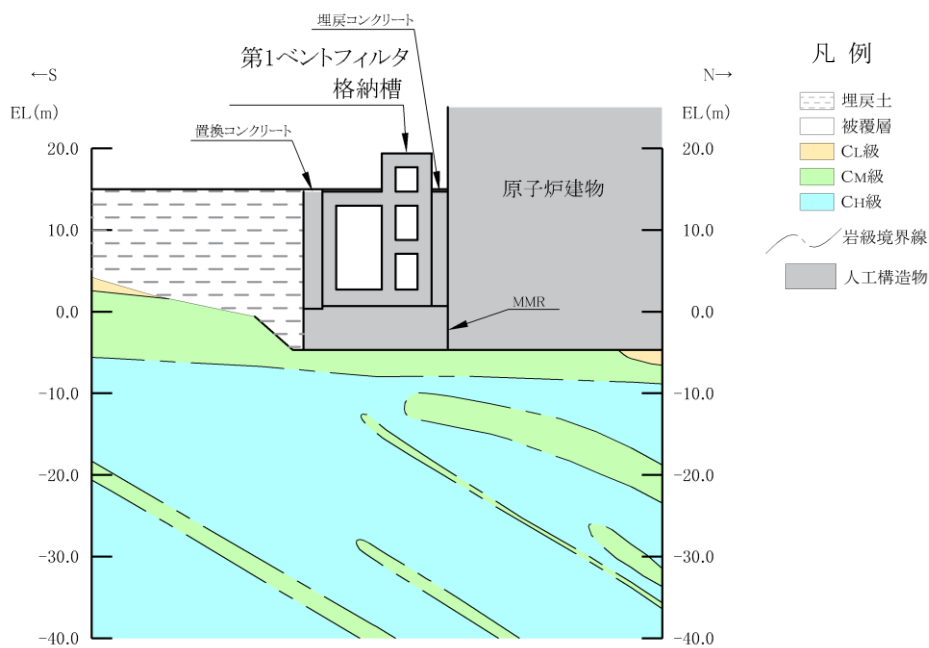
第 1 ベントフィルタ格納槽 評価対象断面図 (A-A 断面)
